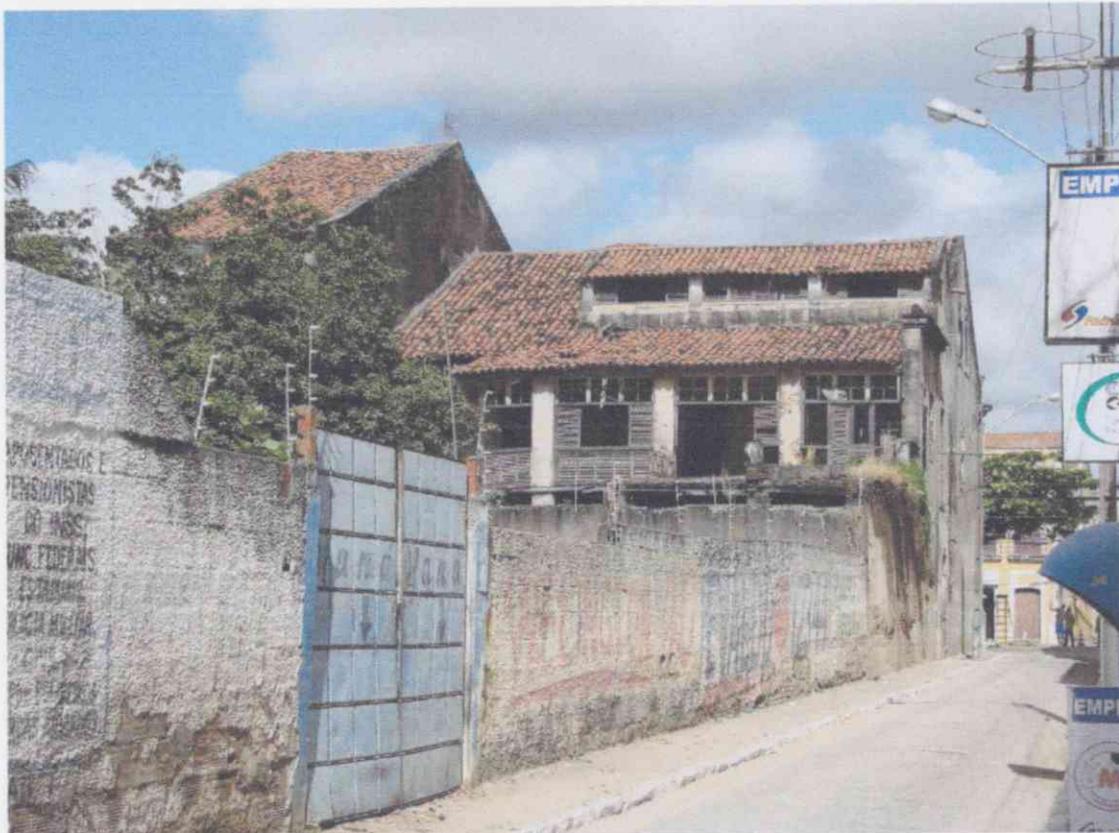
Fachada posterior da edificação vista a partir da Tv. Barão de Messejana.
